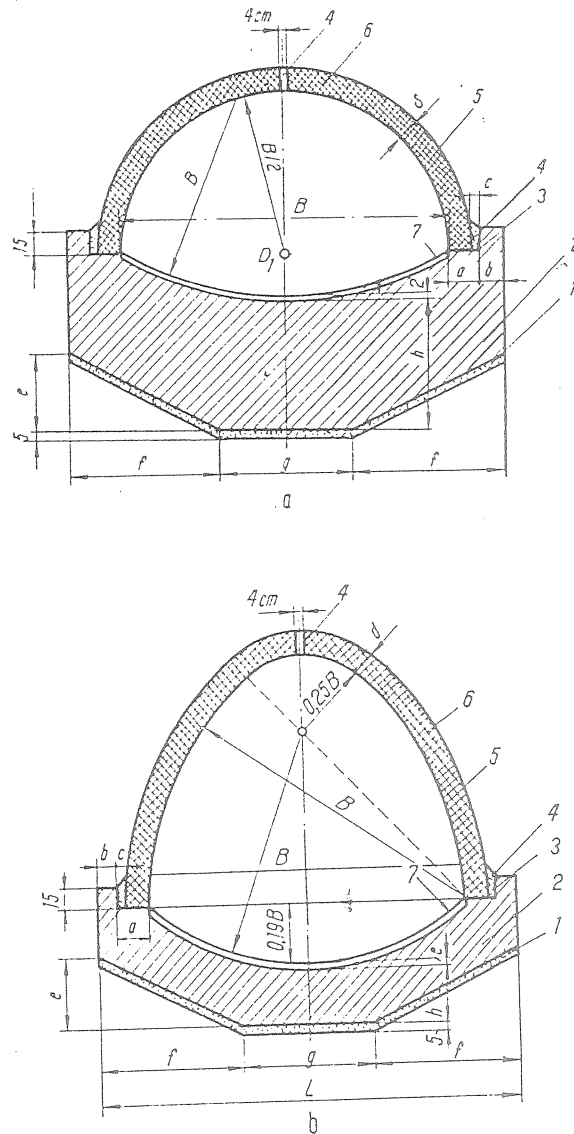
Canal clopot semifabricat din beton armat:
